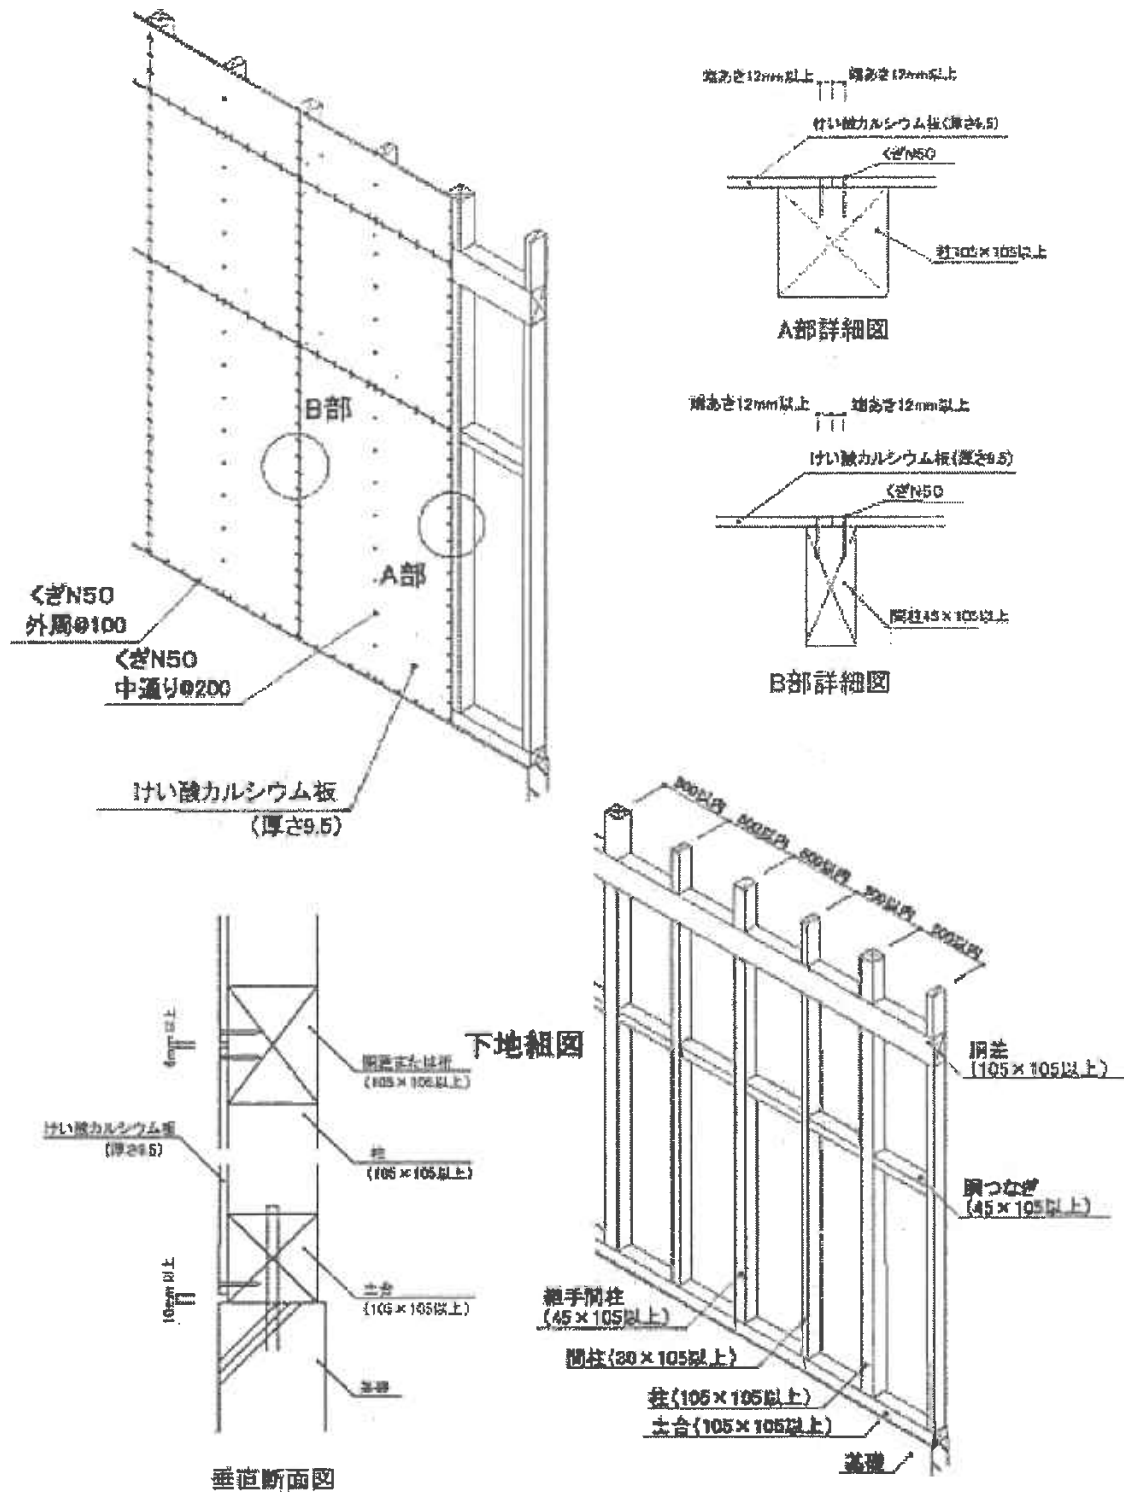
施工図：継手を設ける場合（寸法単位：mm）
